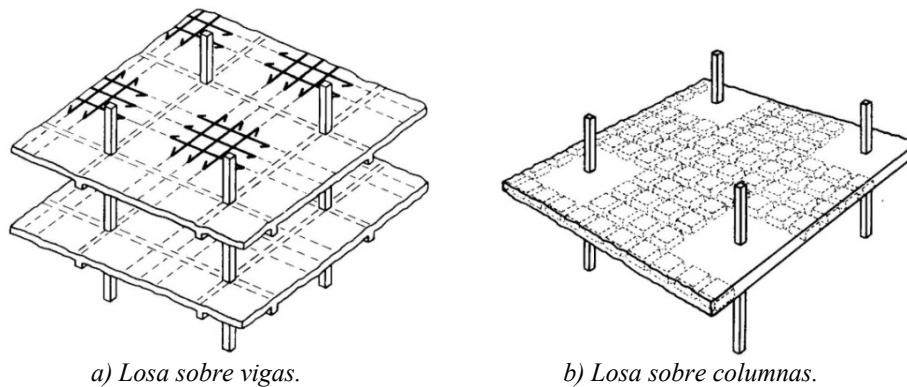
Losas apoyadas en vigas y columnas.
